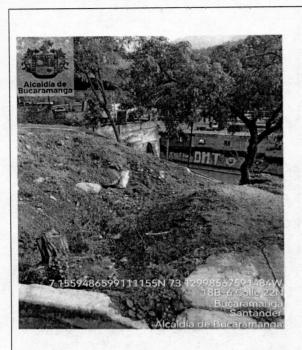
Excavación para instalación de tubería que conduce hacia la carrera 18 entre calle 22N y Calle 20N Barrio: Villa Rosa
